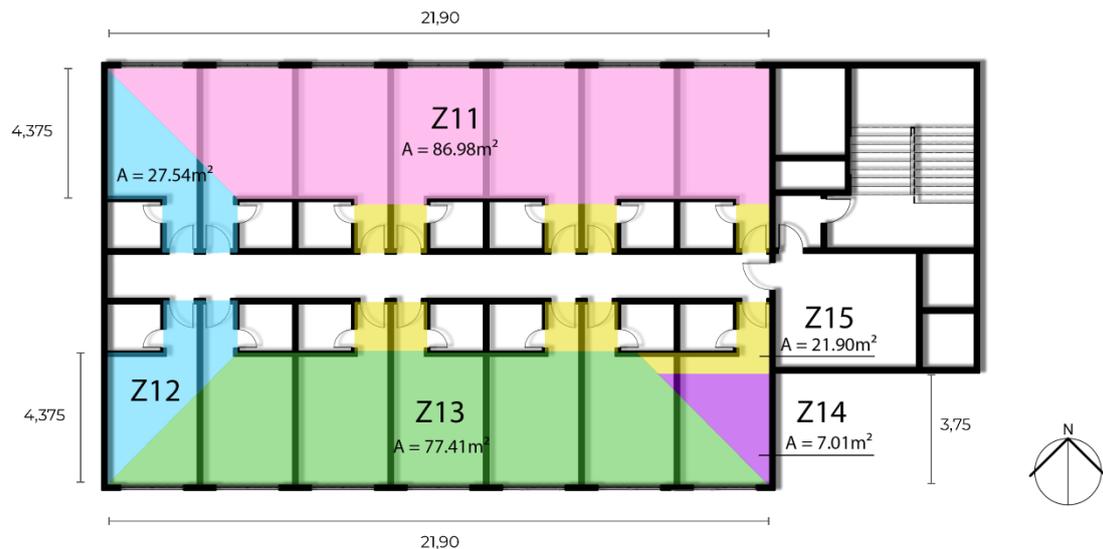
Zonas térmicas do pavimento tipo (3x)
